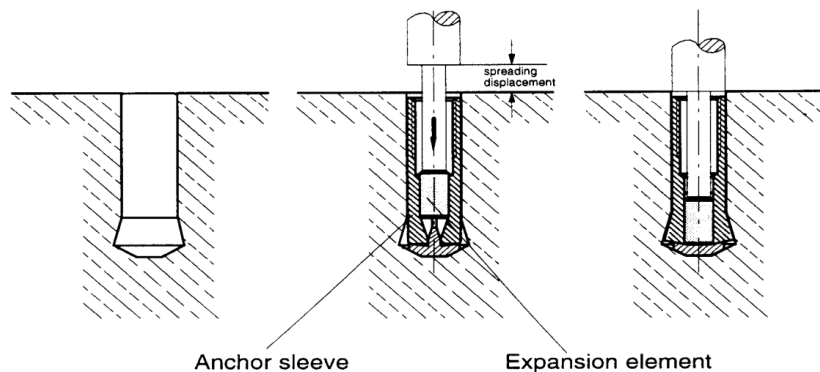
Sistemi di fissaggio meccanici per sottosquadro
